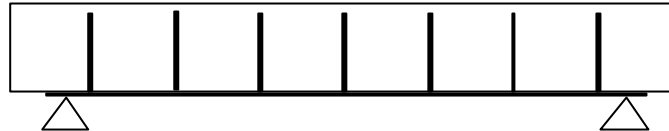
Viga reforçada à flexão e ao cisalhamento através de barras coladas
